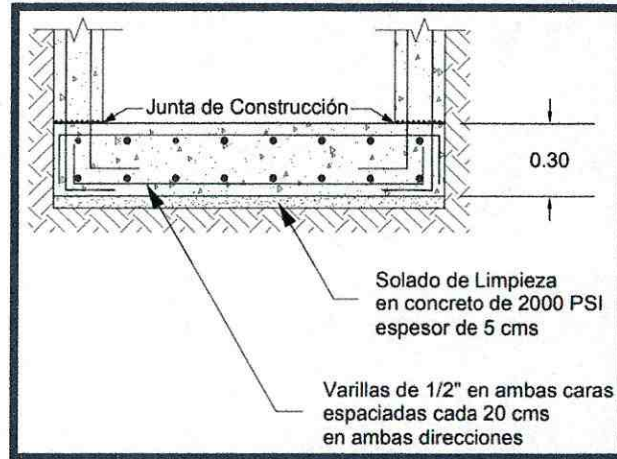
Corte lateral de la placa de fondo del pozo de inspección
